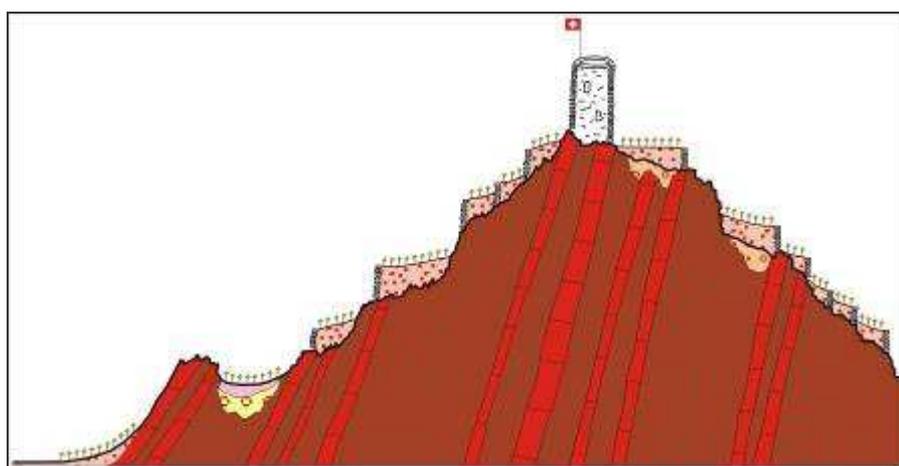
Schéma de tablars en pierres sèches construits sur crêtes rocheuses (Type 'Clavaux')
